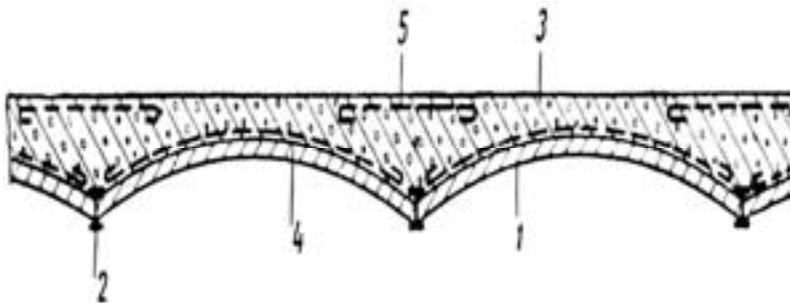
Підсилення склепіння з укладанням додаткової арматури; 1 – існуюче склепіння; 2 – металева балка; 3 – монолітний залізобетон; 4 – додаткова арматура; 5 – додаткова опірня арматура.
